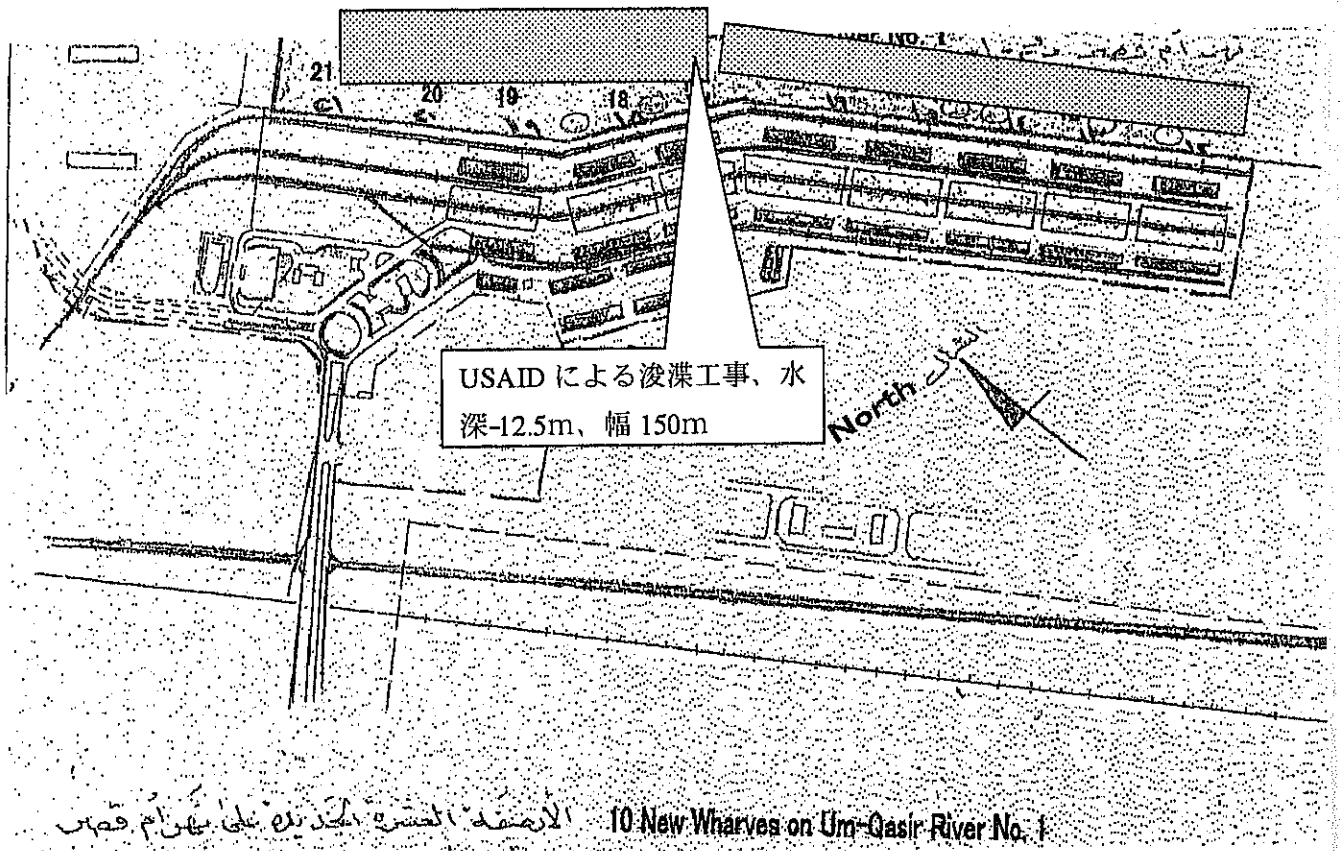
ウムカッスル港湾 新港パース 12-21 平面図
